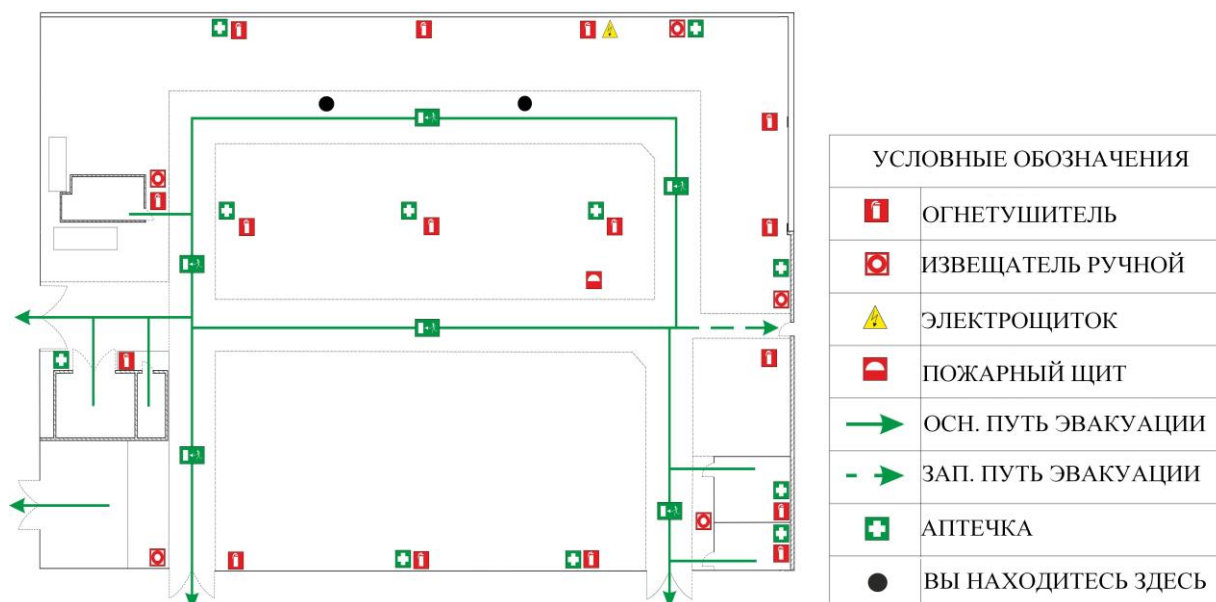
План эвакуации при пожаре сварочно-штамповочный цех
